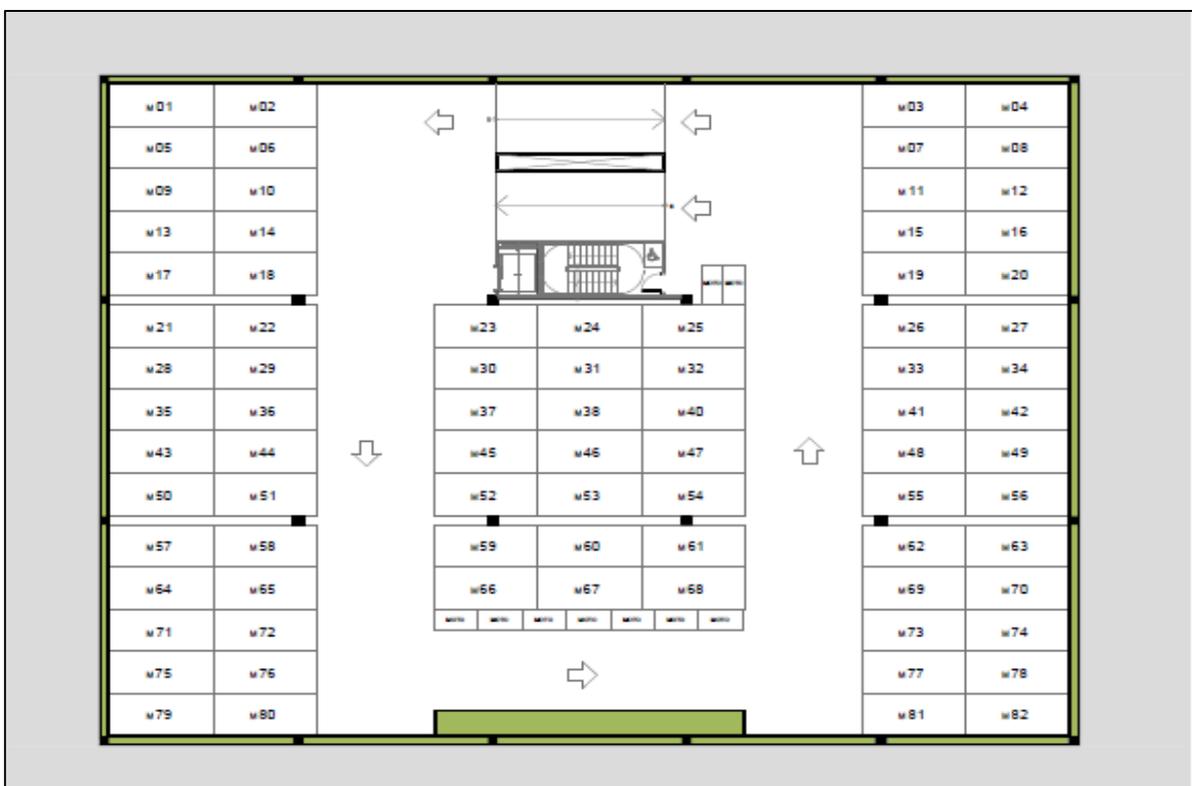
Planta do pavimento tipo, contendo 82 vagas (2º ao 7º andar).
